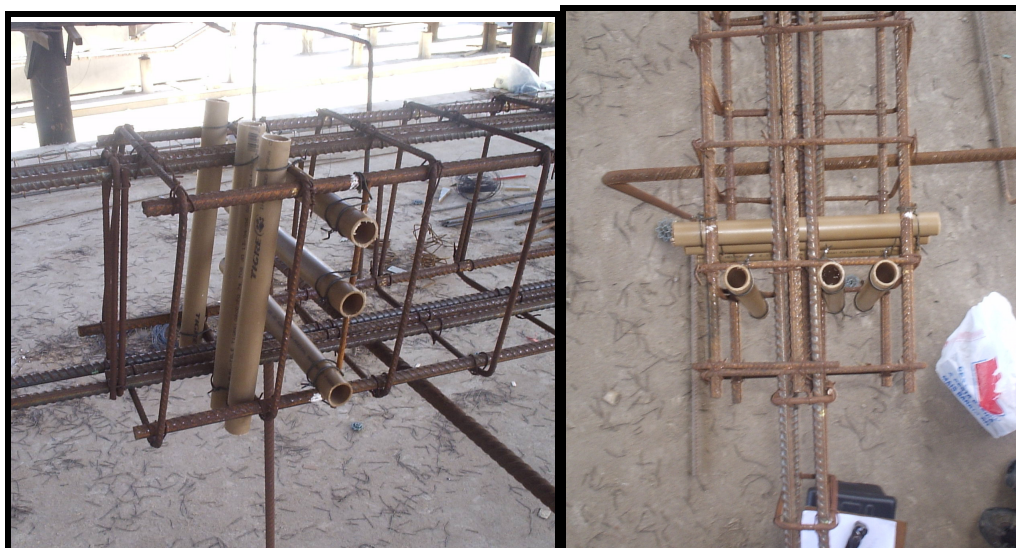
Tubos colocados para furo usado na ligação dos pilares com a laje de reação
